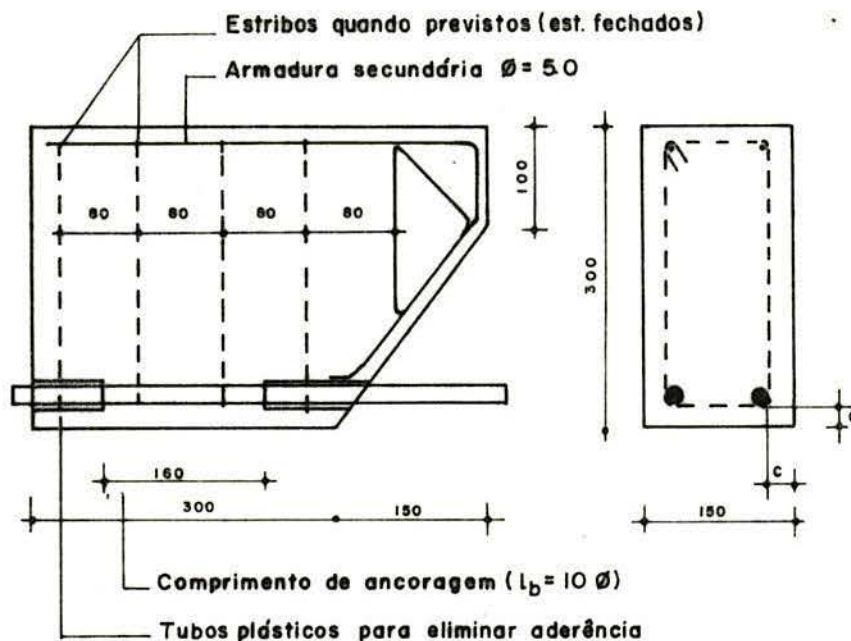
Dimensões e armadura dos CP "de extremo de viga".
